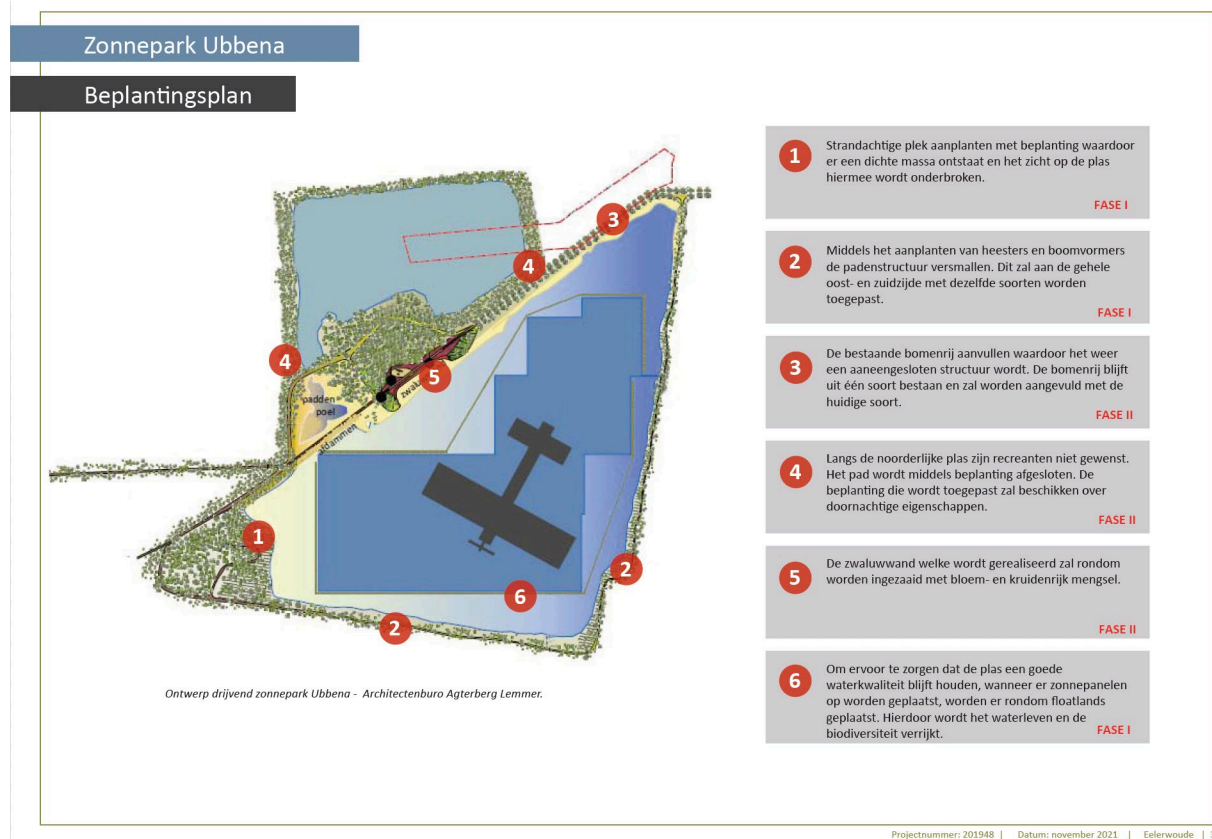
a.2 Uitwerking van het landschappelijke inpassingsplan met Transformator positionering (Bron: Architectenburo Agterberg)
